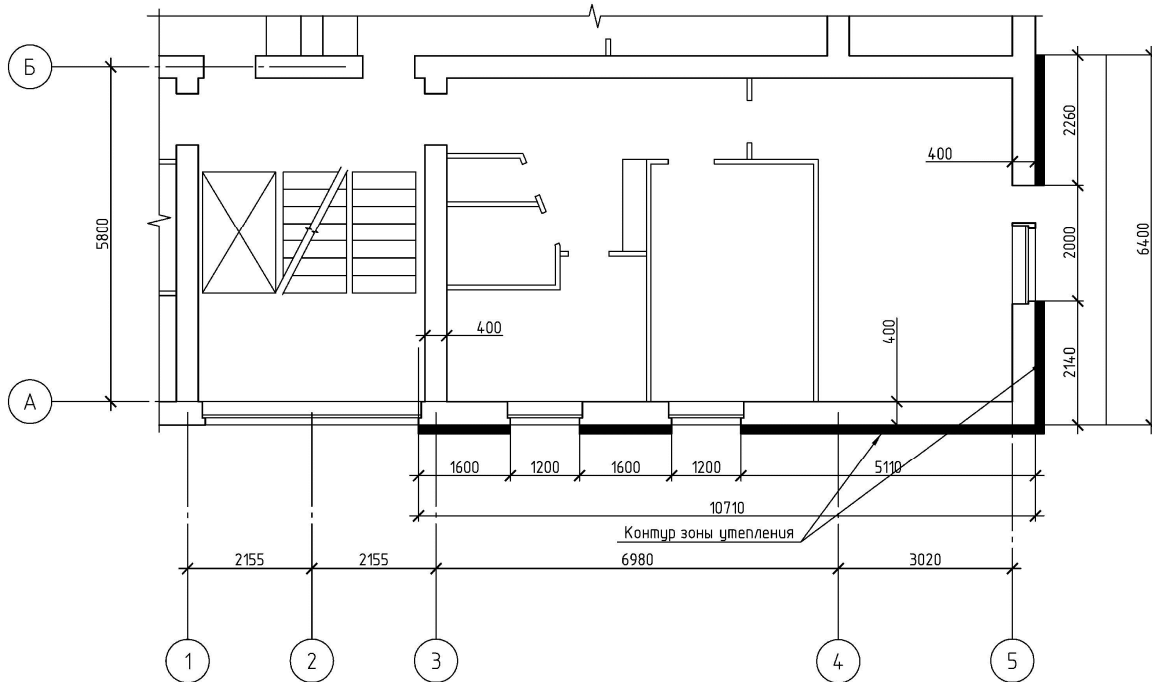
План утепляемой квартиры / Plan to insulate the apartment
